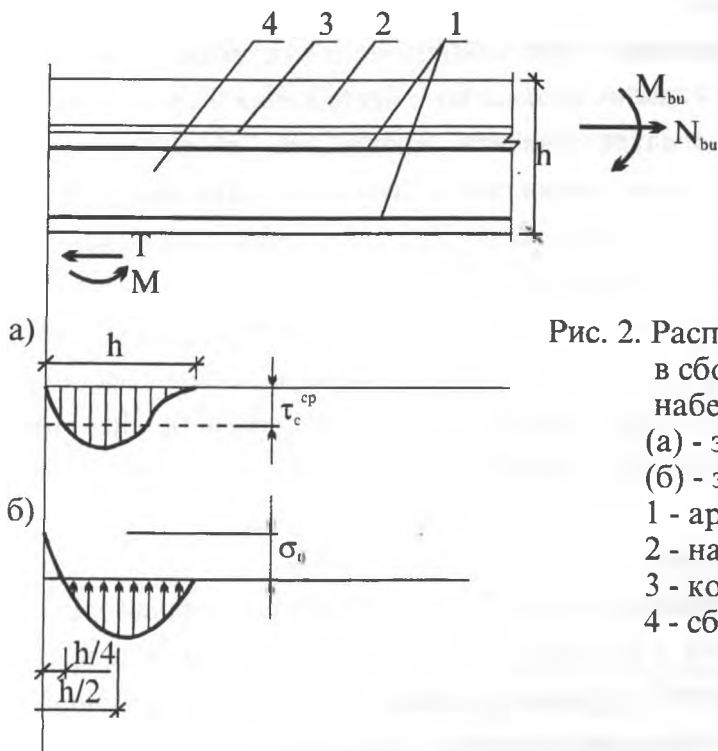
Распределение сдвигающих усилий в сборно-монолитном элементе с набетонкой из напрягающего бетона (а) - эпюра сдвигающих усилий; (б) - эпюра нормальных напряжений. 1 - арматура; 2 - набетонка из бетона на ПЦ; 3 - контактный слой; 4 - сборный элемент.
